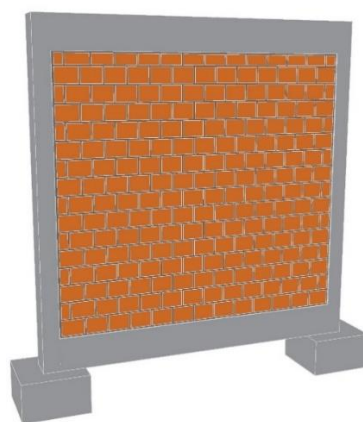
Modelo da parede menor em concreto armado e alvenaria.
